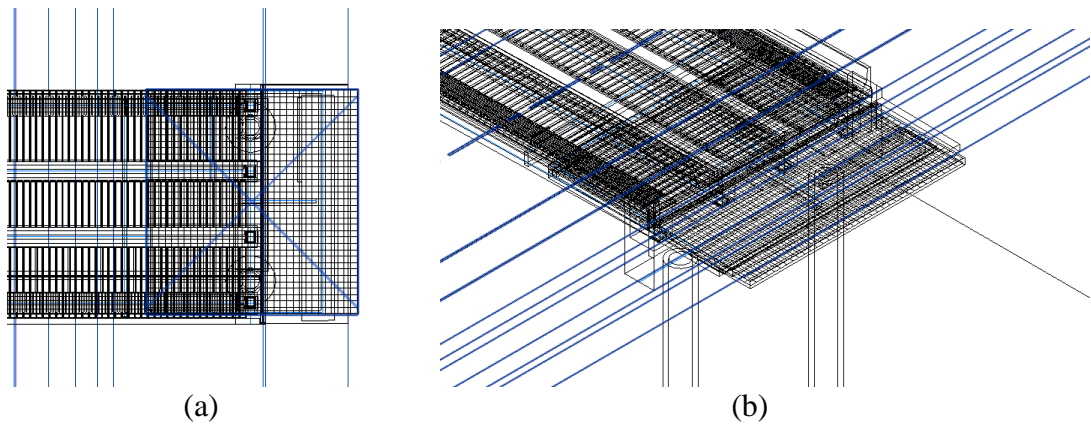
Imagens da armadura da lajona estrutura: (a) vista superior; (b) vista em perspectiva
